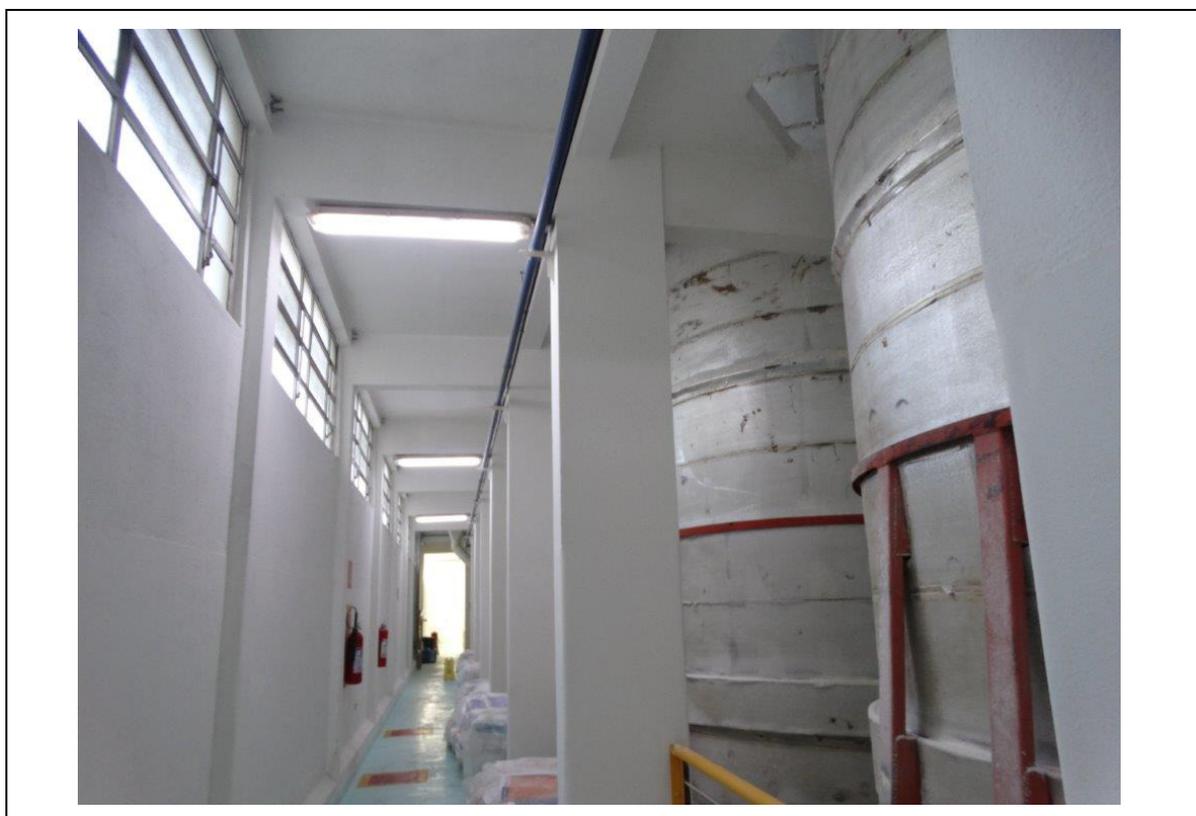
PRÉDIO H0 - 2º ANDAR.
